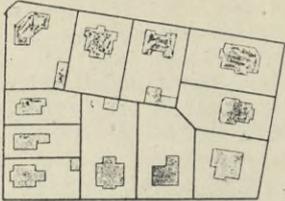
Offene Bauweise mit großen Abständen und kleinen Nebengebäuden. 1:4000. Nur bei sehr billigem Gelände oder sehr hohen Mieten durchführbar
